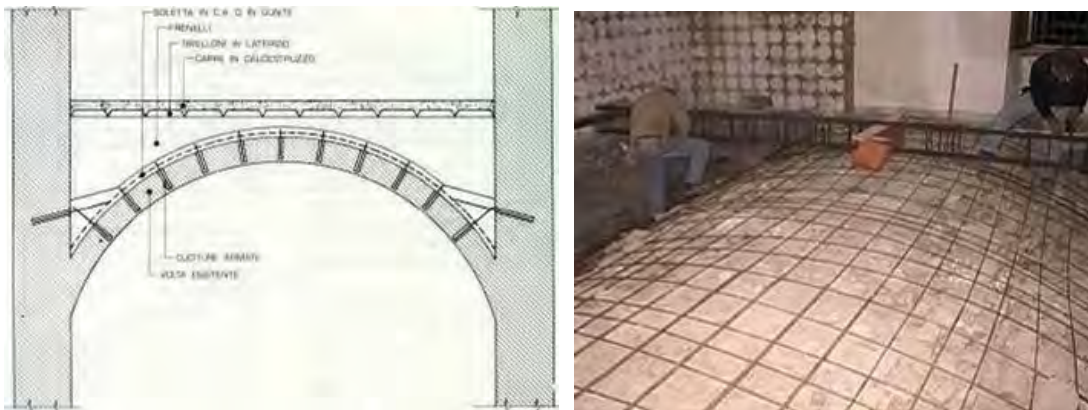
Rinforzo estradossale con cappa in calcestruzzo armato
